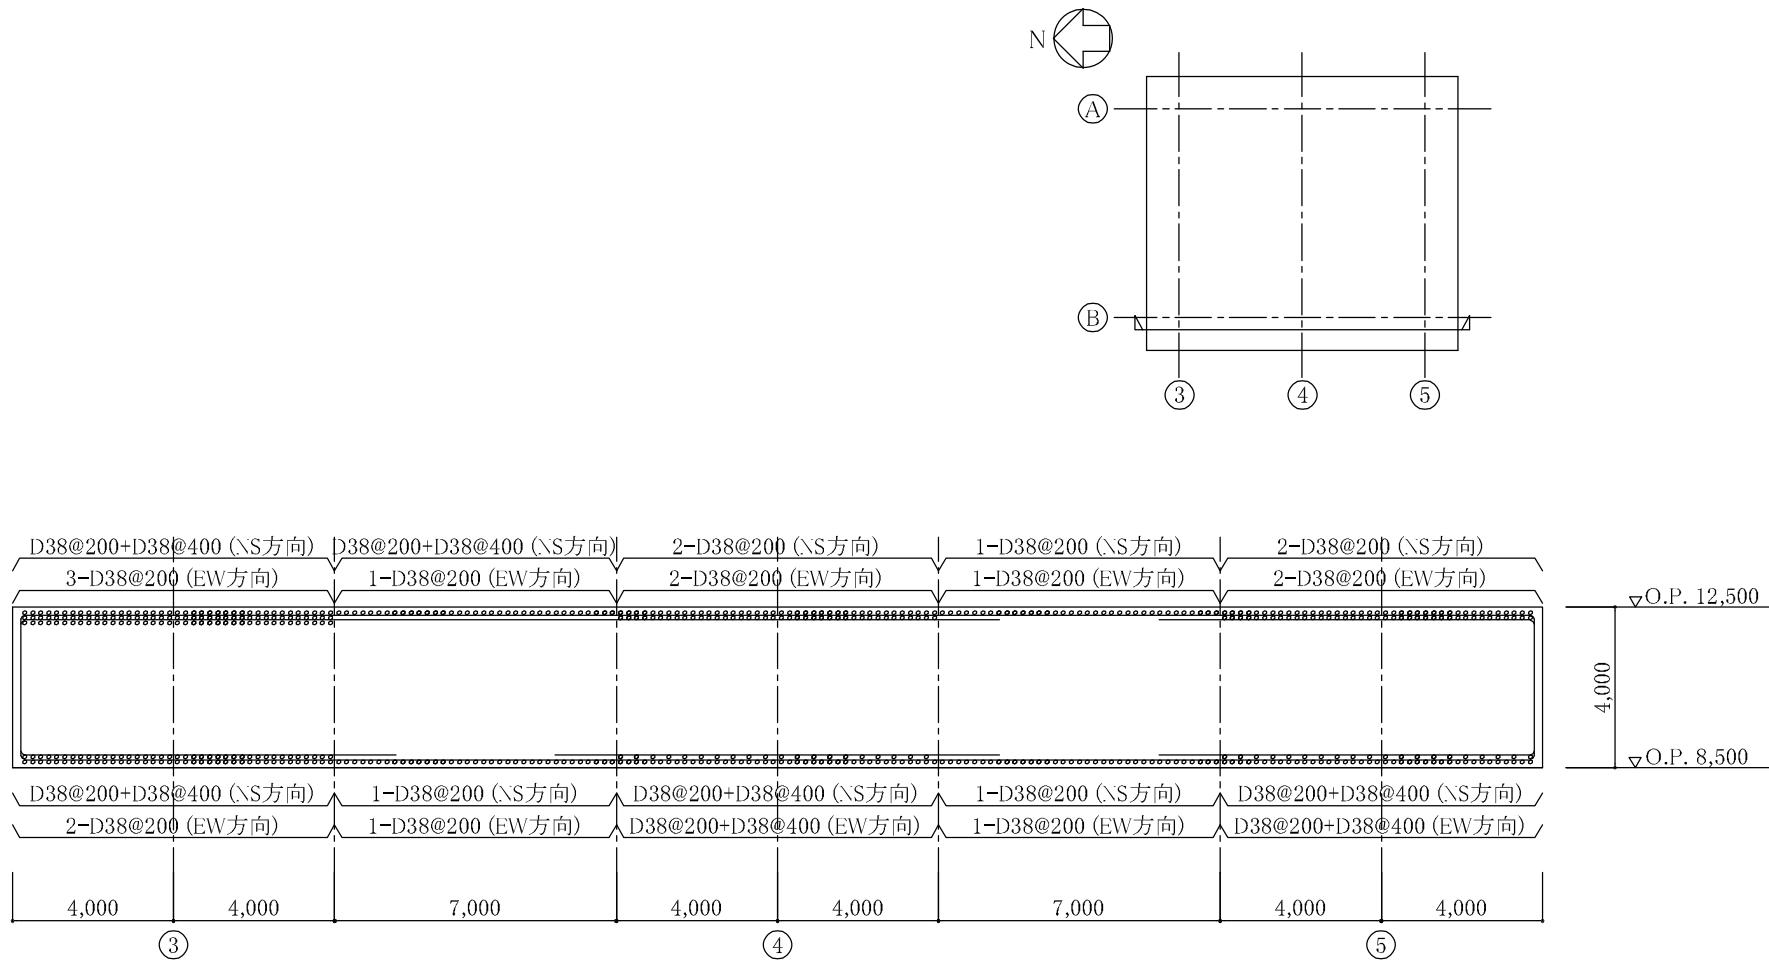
基礎スラブの配筋図 (B 通り) (単位 : mm)
